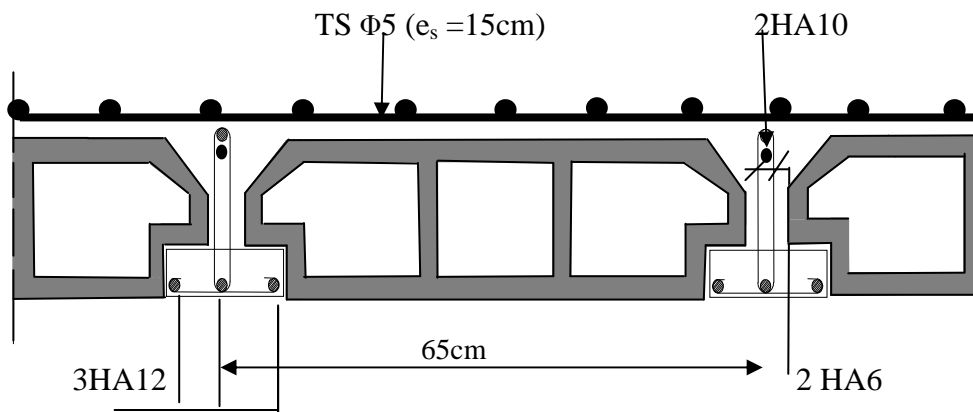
Plan de ferrailage du plancher en corps creux.
